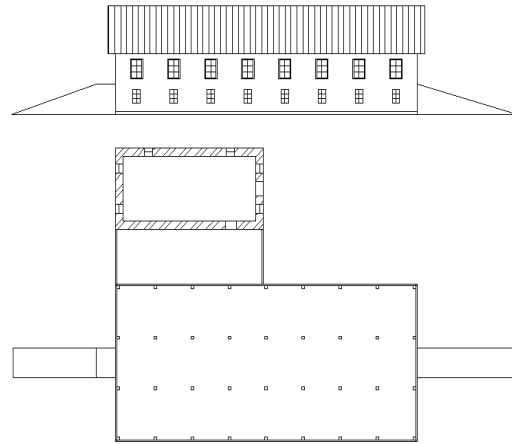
Фасад и план лесопильного завода в урочище Хабище. 1911 г.
